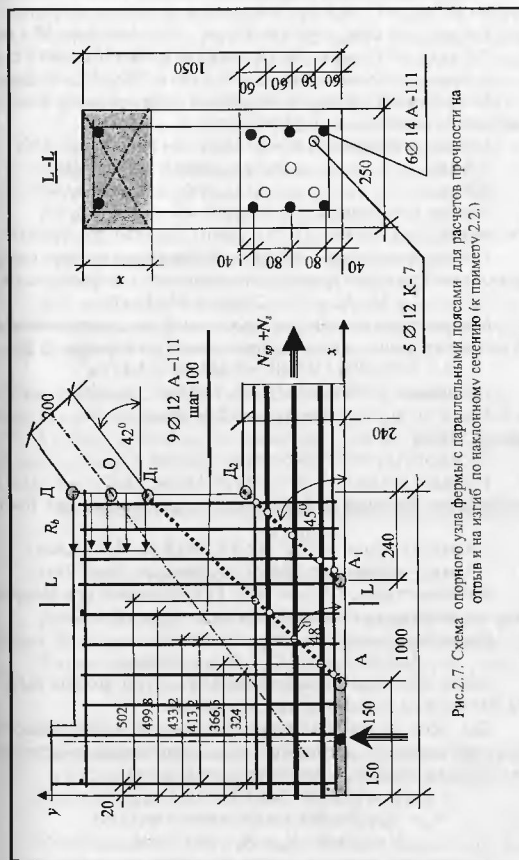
Схема опорного узла фермы с параллельными поясами для расчетов прочности на отрыв и на изгиб по наклонному сечению (к примеру 2.2.)
